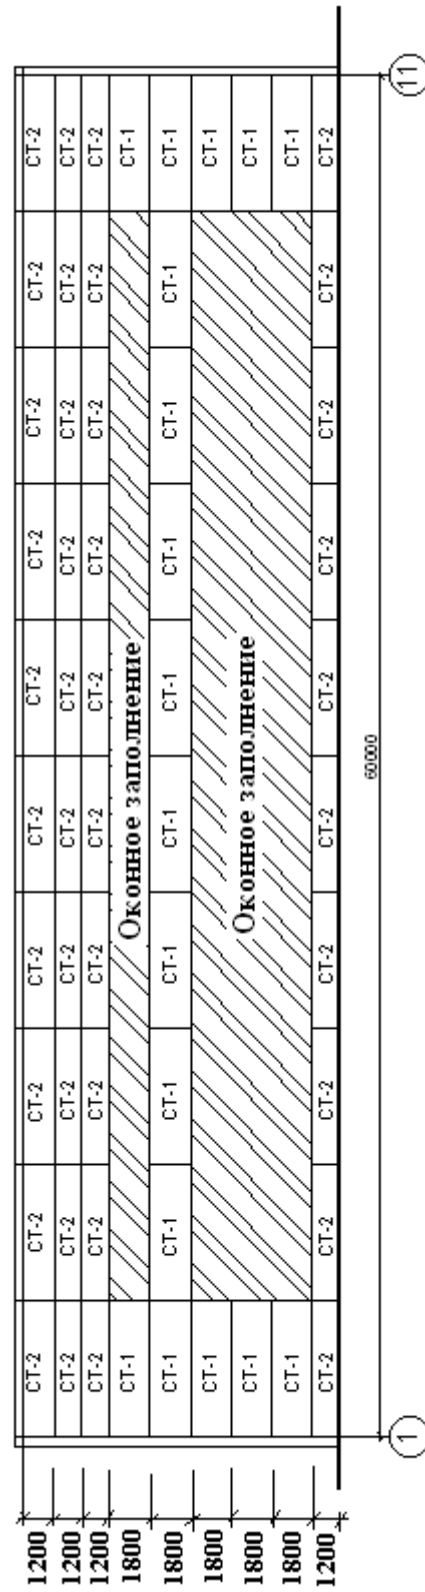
Примерная схема расположения стеновых панелей по фасаду здания в осях 1–11
